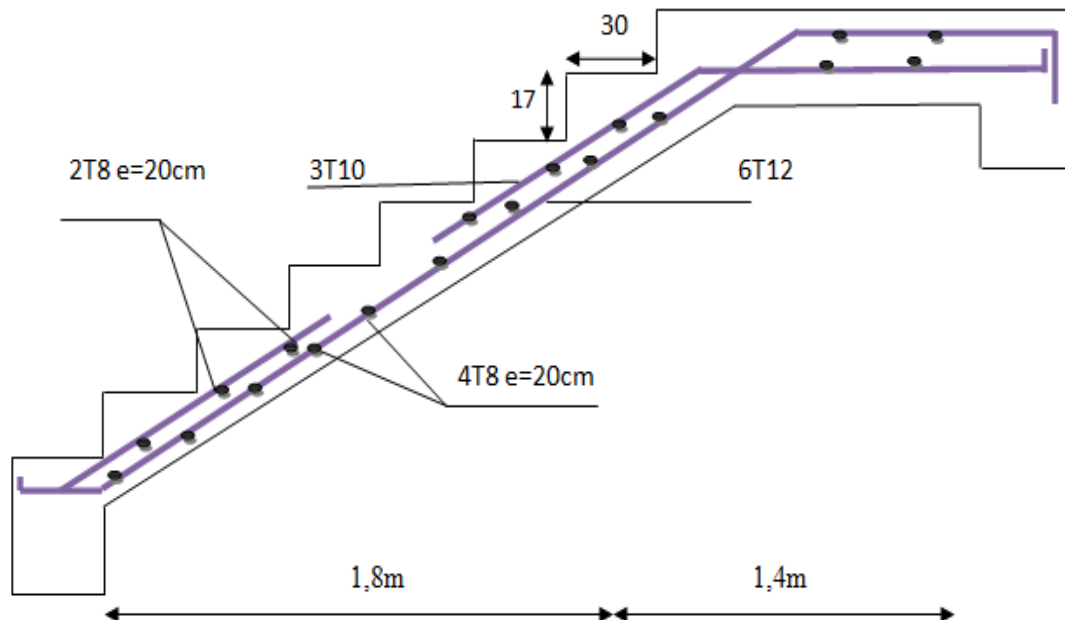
Schéma de ferrailages d'escaliers (types 1).
